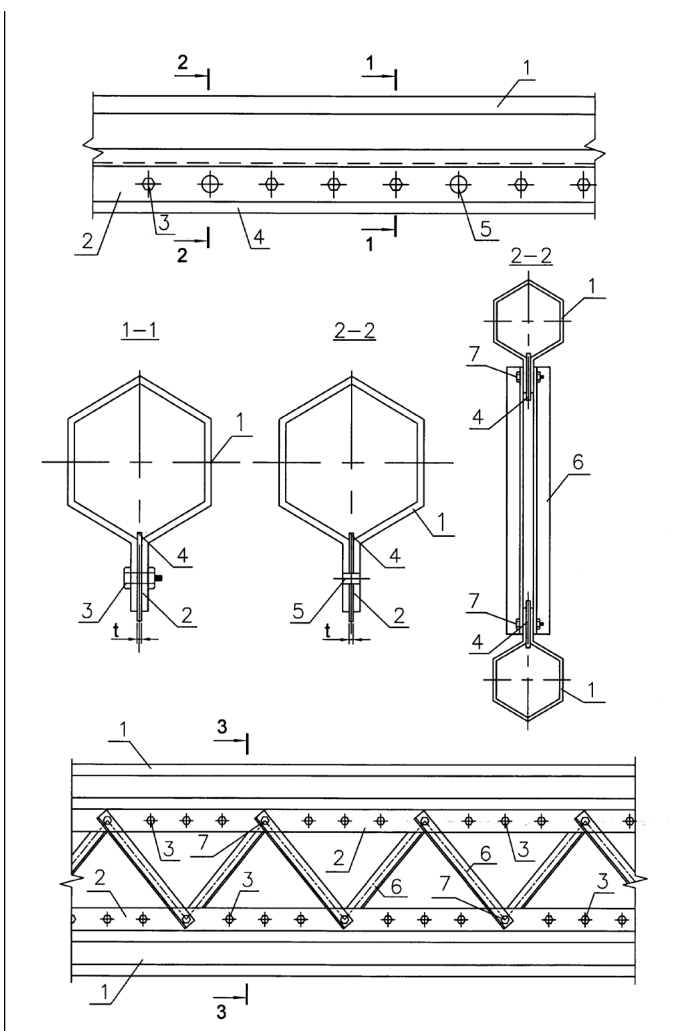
Схемы строительного элемента для изготовления решетчатых (ферменных) конструкций: 1 – поясной стержень замкнутого сечения; 2 – кромки ребра; 3 – поясной болт; 4 – листовая полоса; 5 – отверстие; 6 – стержень решетки; 7 – болтовое соединение пояса и стержней решетки
